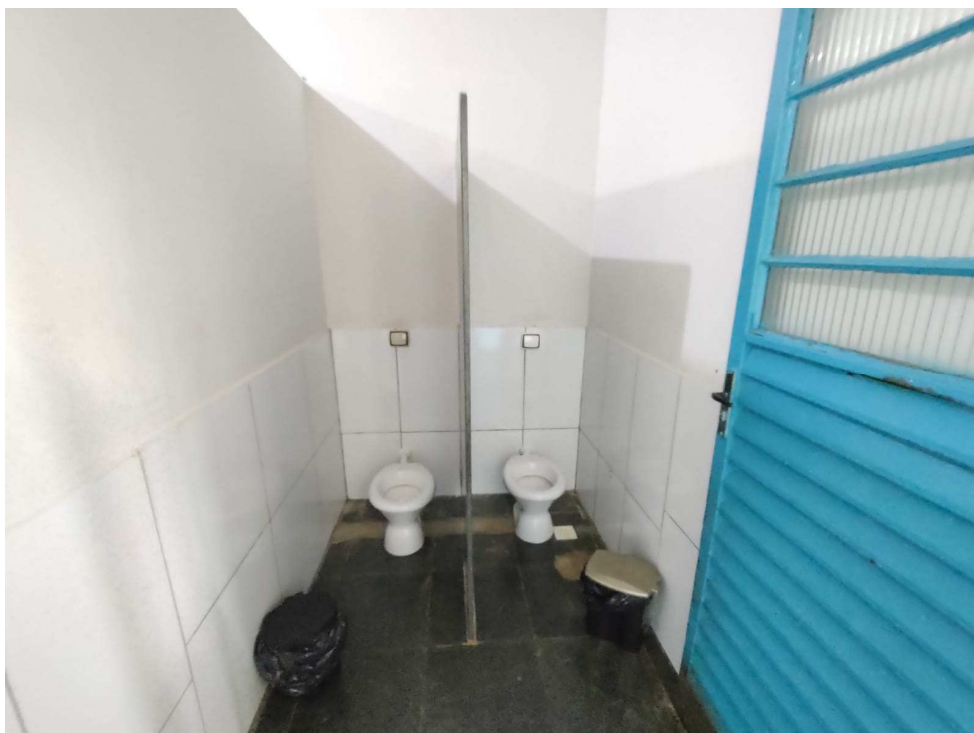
(Banheiro onde será colocado piso e portas nas divisórias);
